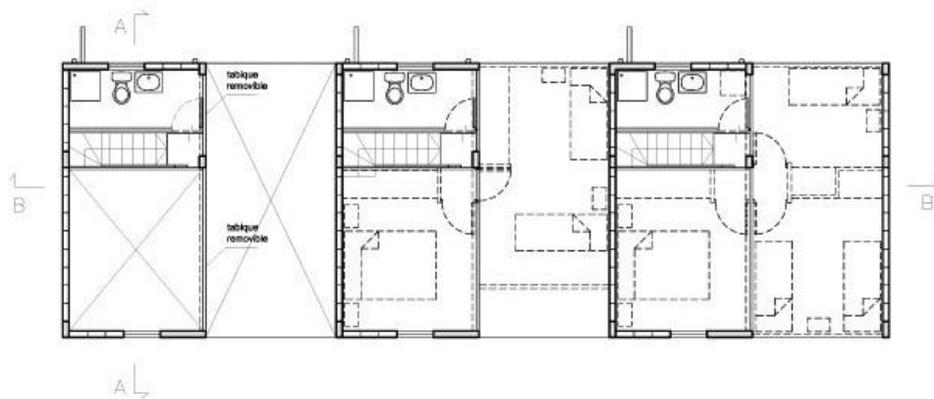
Planta baixa, terceiro piso. Projeto Elemental para Quinta Monroy.
